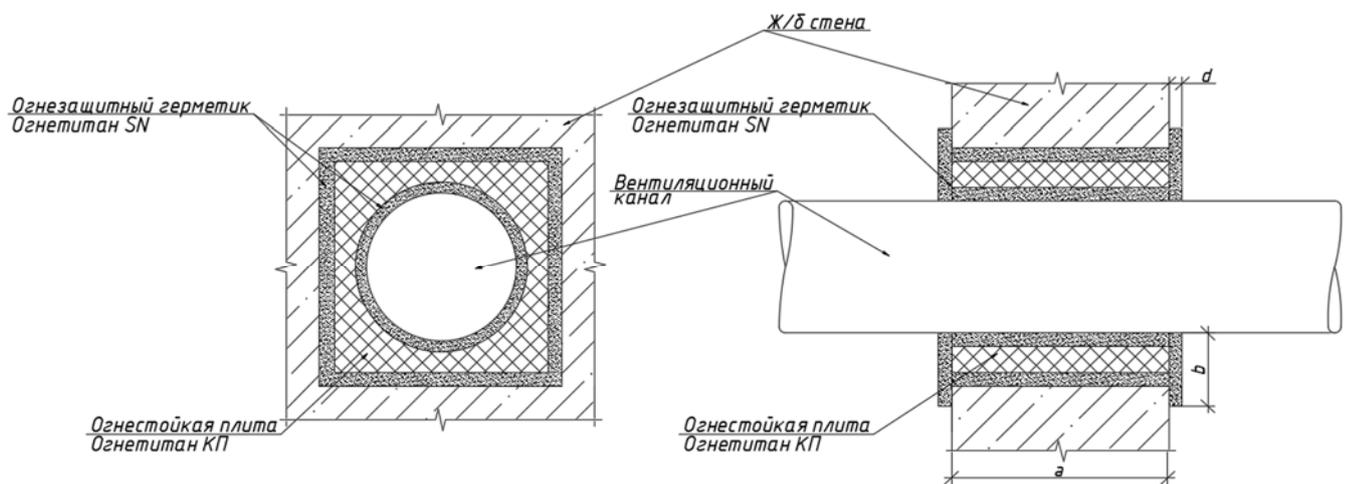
Огнестойкая заделка вентиляционных проходок круглого сечения
